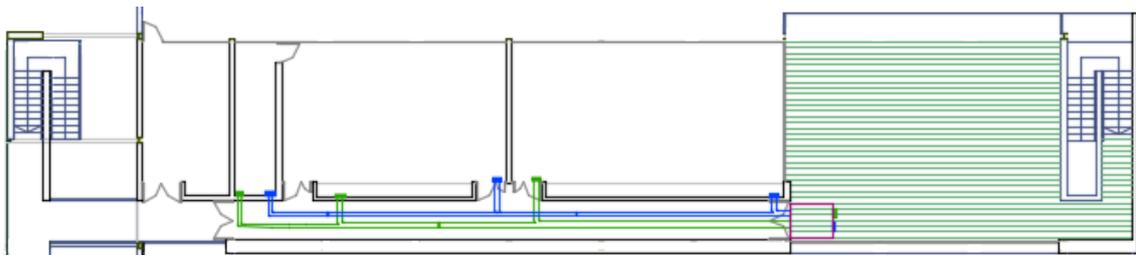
Diseño de la instalación de ventilación, Edificio 5 Primera Planta
